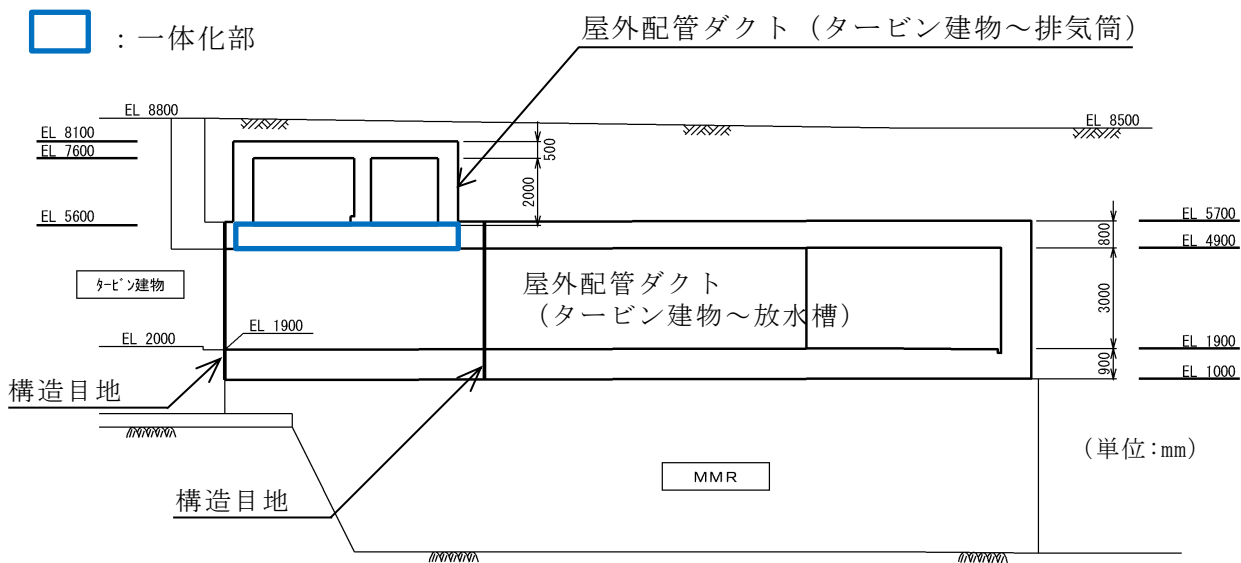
屋外配管ダクト（タービン建物～排気筒） 断面図（B-B断面）
